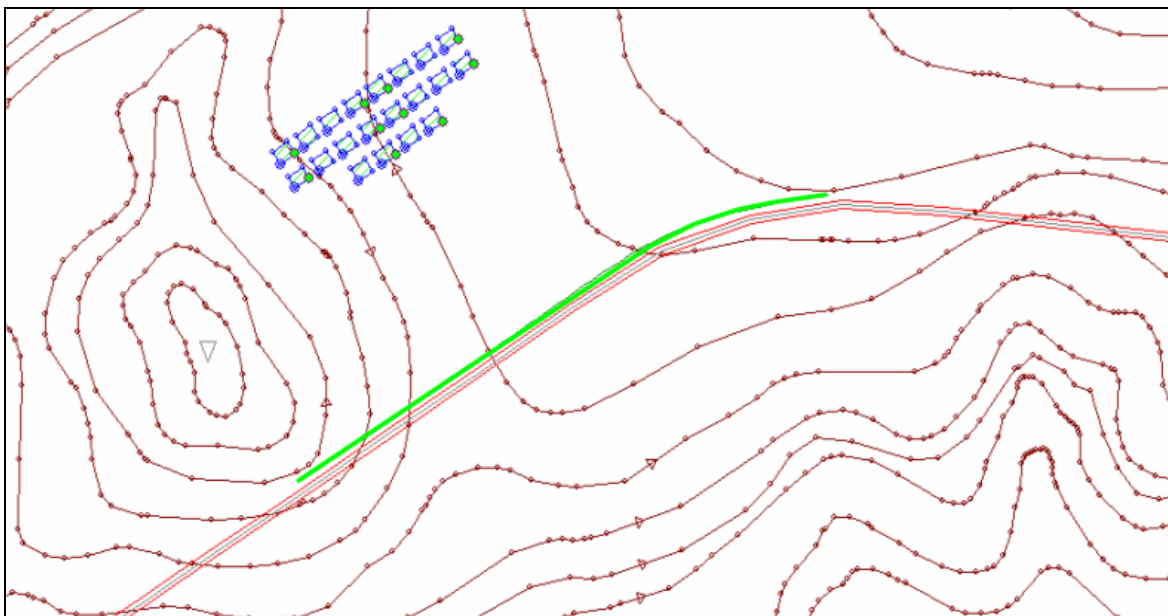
Lageplan des untersuchten Geländemodells mit einer 275 m langen Lärmschutzwand
